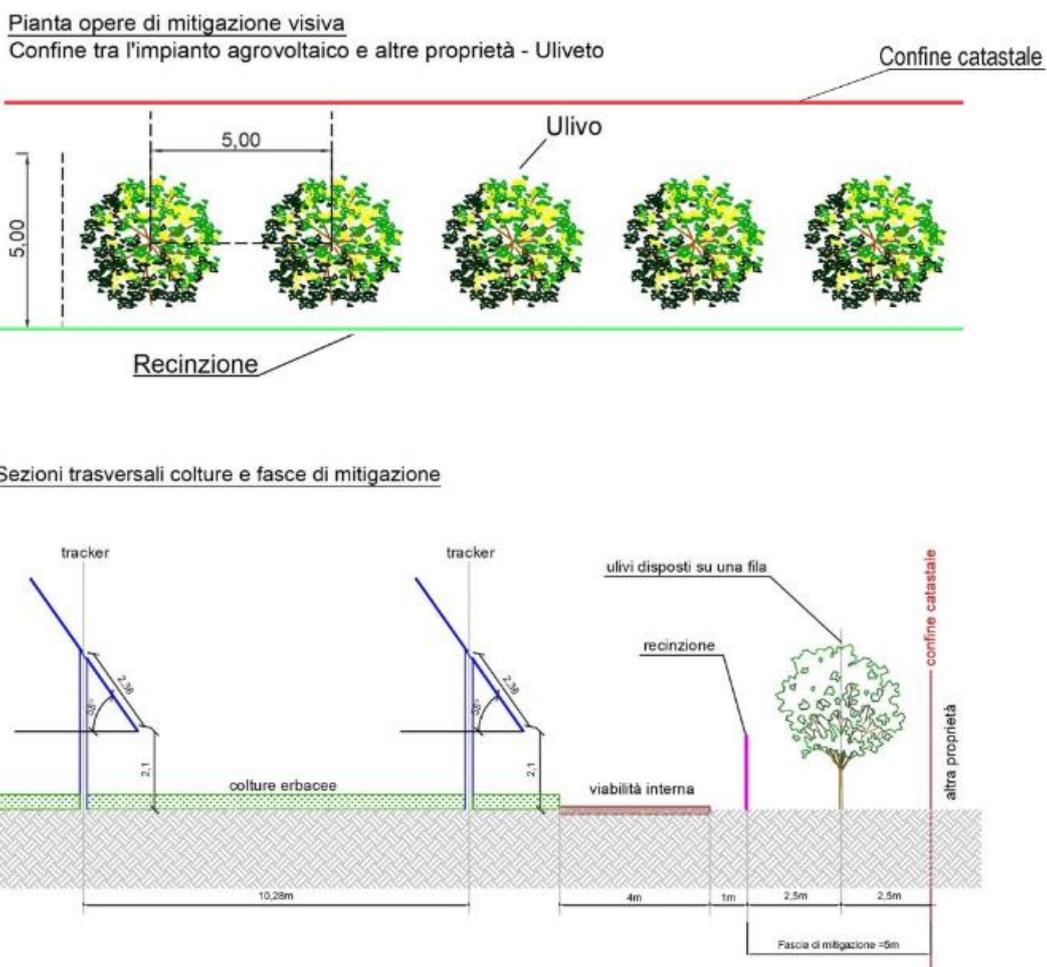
Fascia di mitigazione tipo : pianta e sezione
